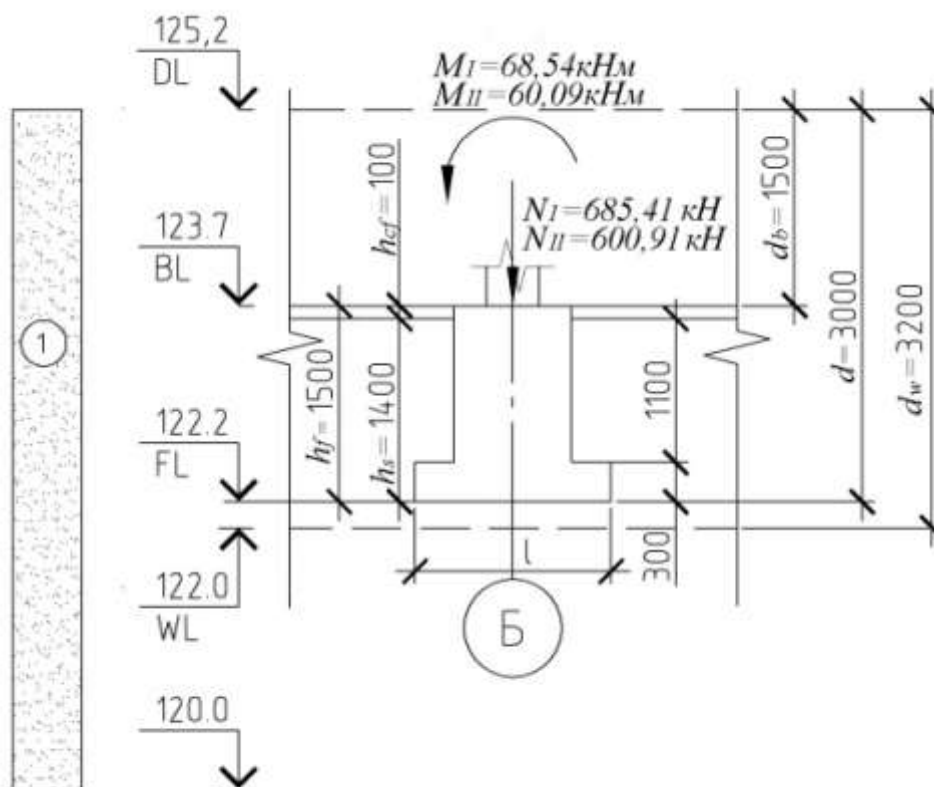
Расчетная схема к примеру 8.1.2
